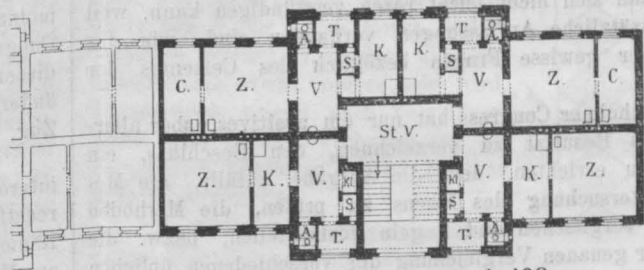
Grundriss der Reihenhäuser. 1:400.
